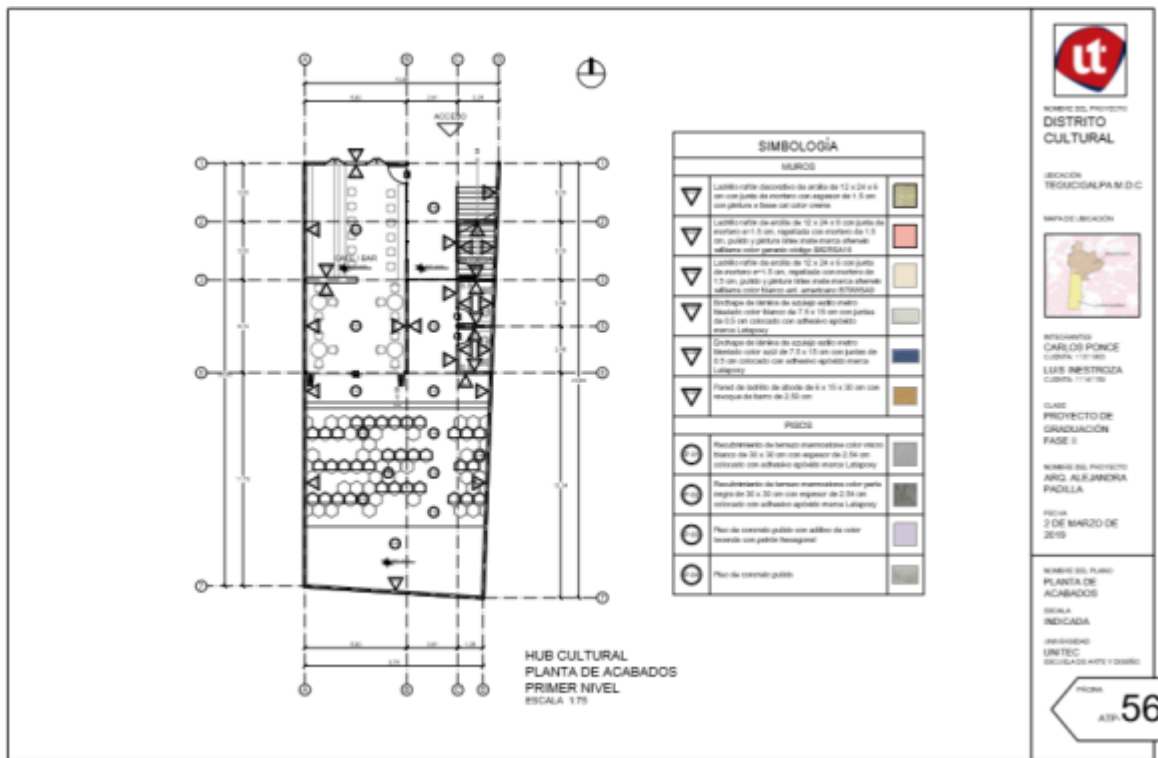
Planta de Acabados Hub Cultural Primer Nivel
